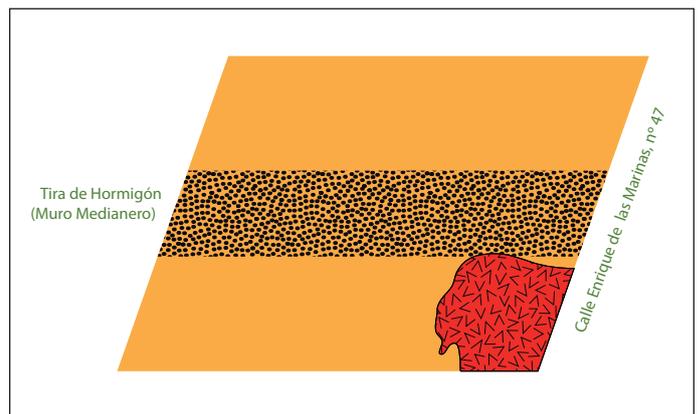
Croquis del muro medianero y del pavimento contemporáneo
